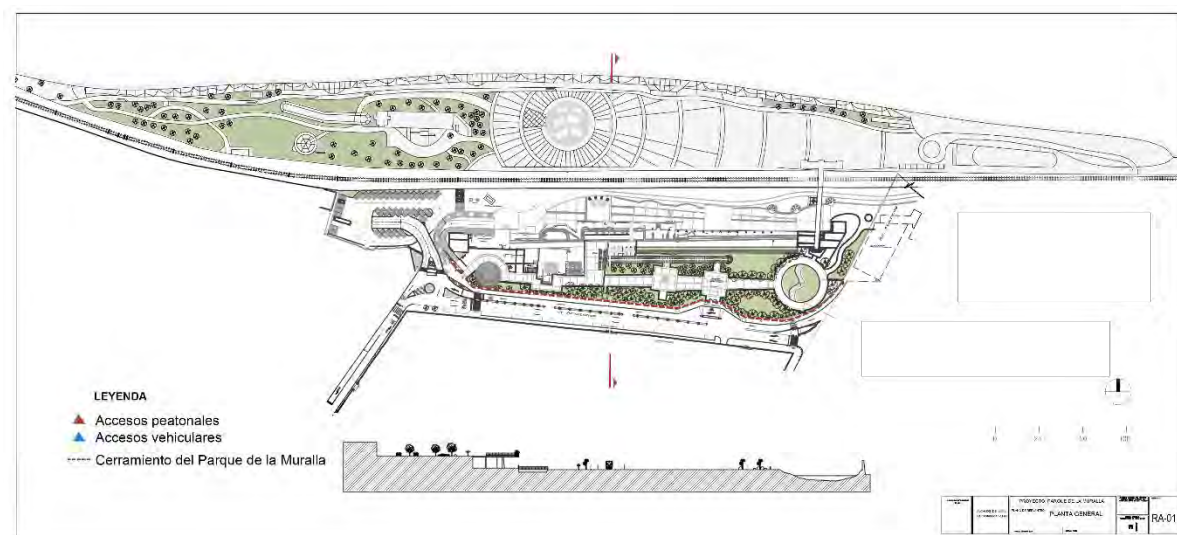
Plano de Remodelación del primer nivel Parque de la Muralla. Fuente: Gerencia de Proyectos y obras SERPAR, 2016.
